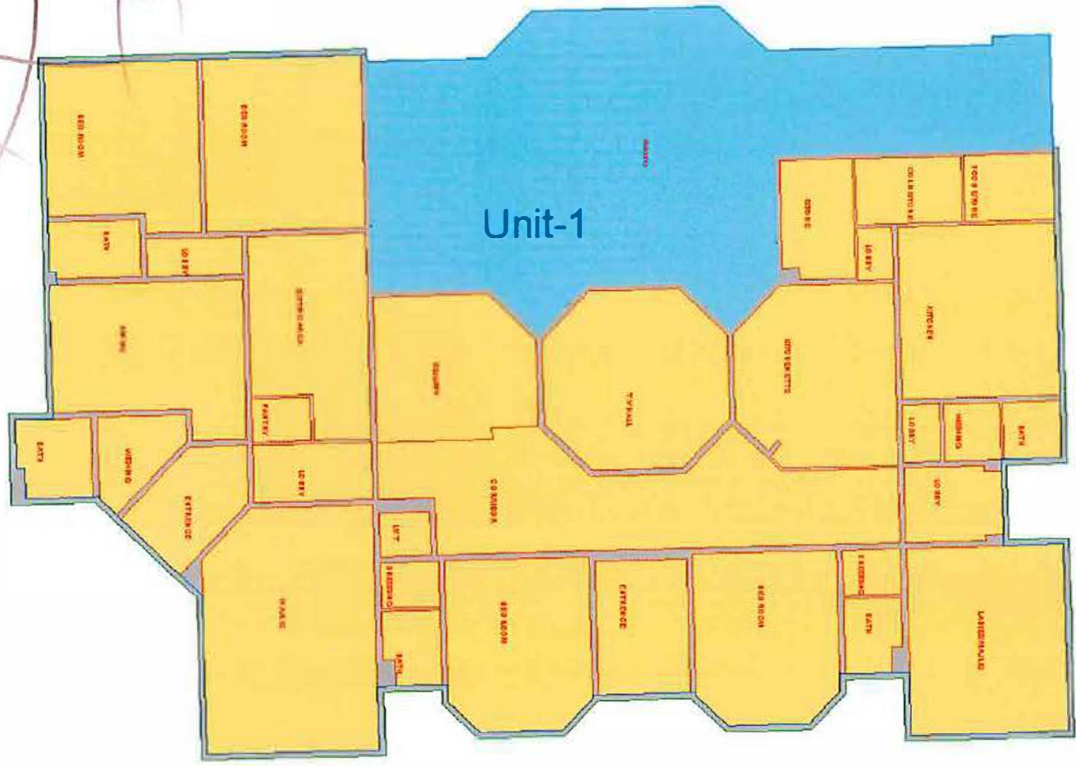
مساحة الطابق العلوي تستثنى المساحات غير المستخدمة من حساب المساحة.
